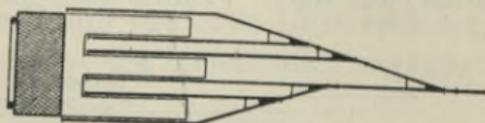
Güterschuppen (Grundriß) mit Kopf- und Zungenladeeinrichtungen.
